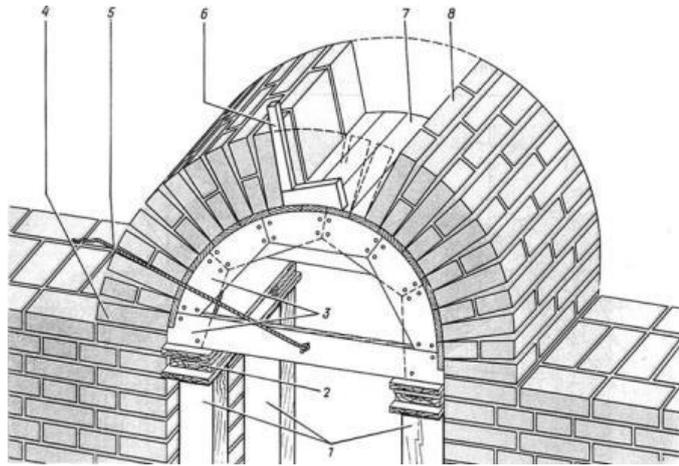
Кладка арочной перемычки: 1 – стойки, поддерживающие опалубку; 2 – клинья; 3 – кружальная опалубка; 4 – пята арки; 5 – шнур; 6 – шаблон-угольник; 7 – дощатая обшивка; 8 – ряды кладки, образующие перемычку
